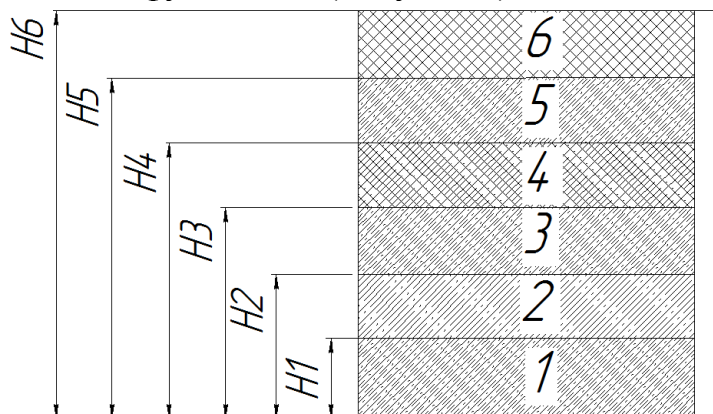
Фундаментное основание низкотемпературного резервуара для хранения СПГ бетонные сваи, 2- слой с теплообменниками, 3- опорный фундамент, 4- амортизирующие прокладки, 5- наружная оболочка, 6- блоки пеностекла.
